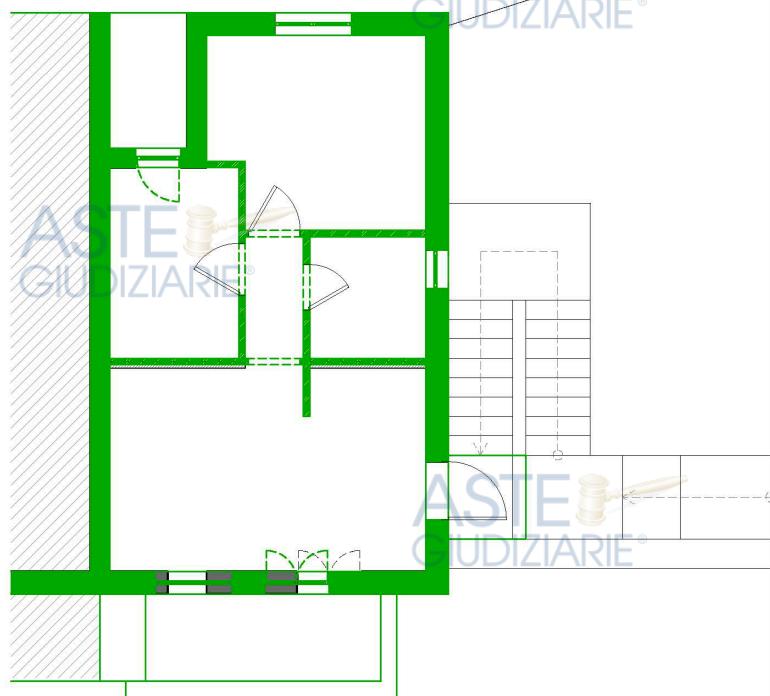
Sovrapposizione planimetria approvata (in verde) su rilievo stato di fatto _ Lotto Unico
